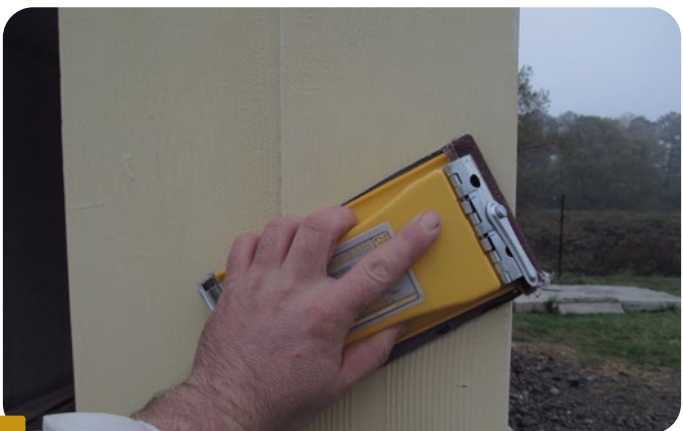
WYKONANIE STRUKTURY DREWNA W ŚWIEŻYM TYNKU BOLIX TR
